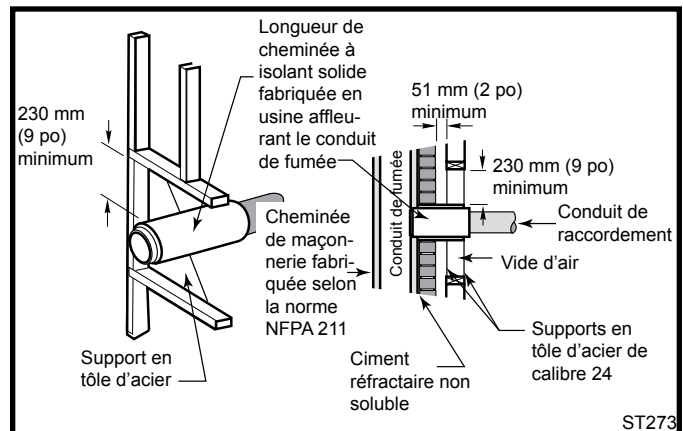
Traversée murale utilisant une section de cheminée isolée fabriquée en usine.
